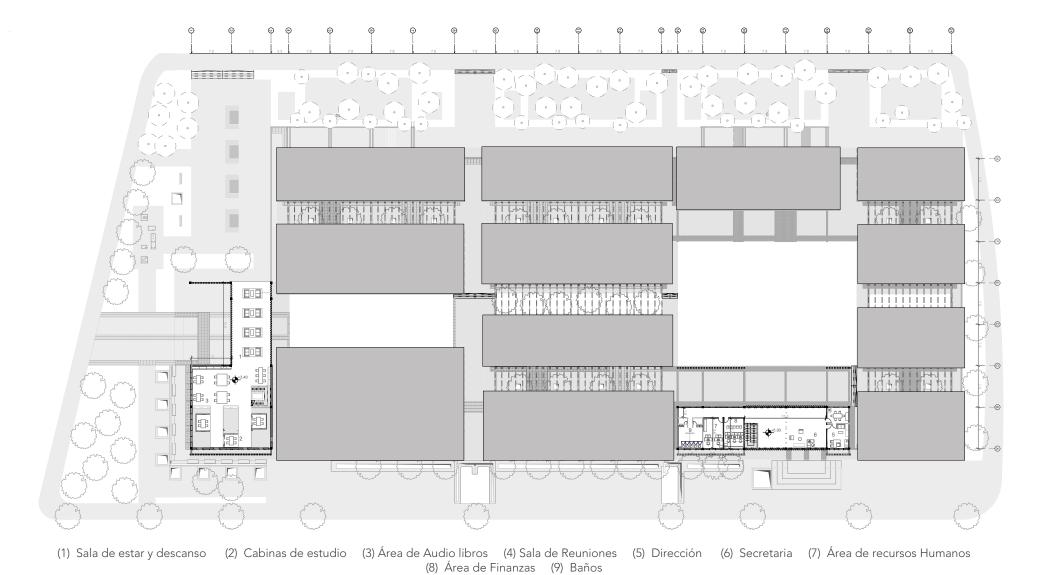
Planta segunda General Fuente: Elaboración propia 2023.
